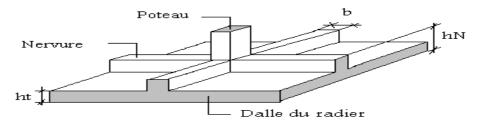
Disposition des nervures par rapport au radier et aux poteaux.
